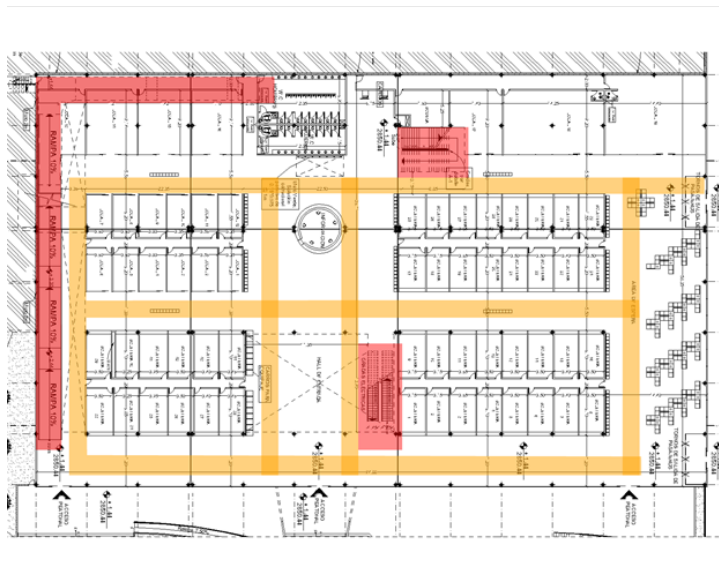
Circulación planta baja, edificio principal del terminal sur de Ambato.
